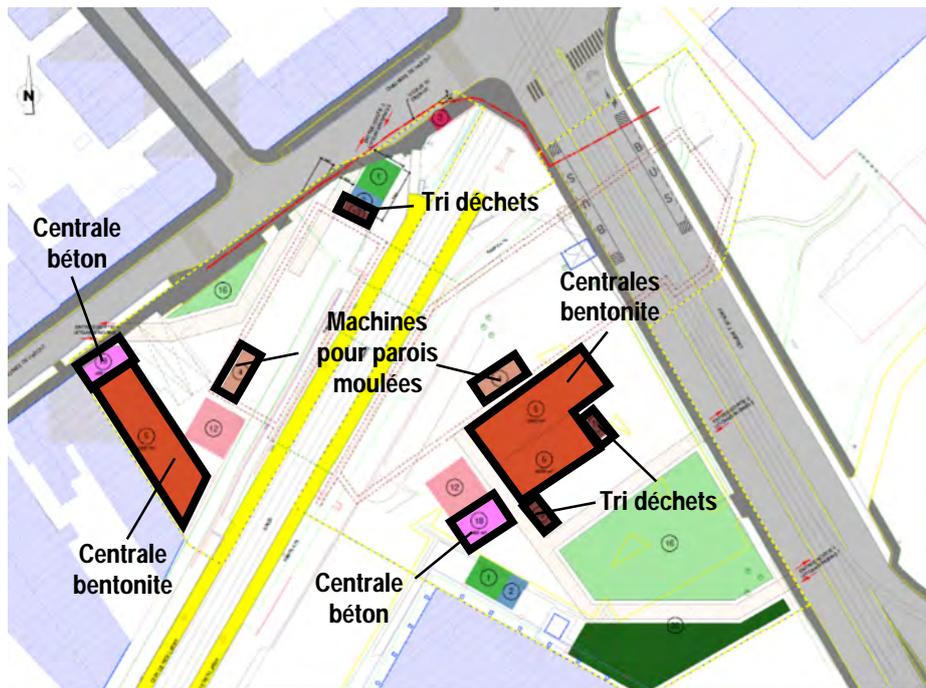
Plan de chantier – Station Bordet (ARIES, 2020 sur fond BMN, 2018)
